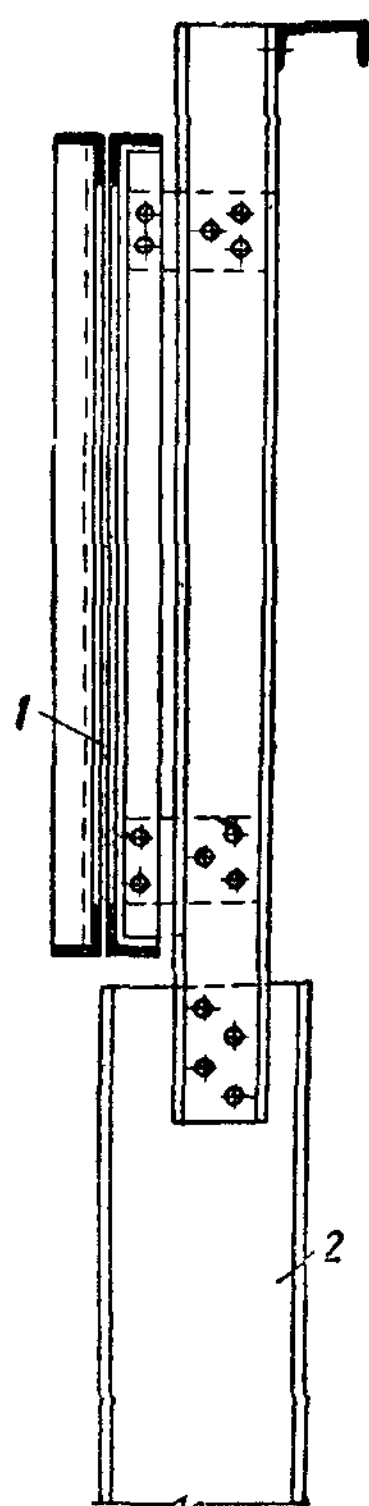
Подвеска стоек фахверка к узлам подстропильной фермы
